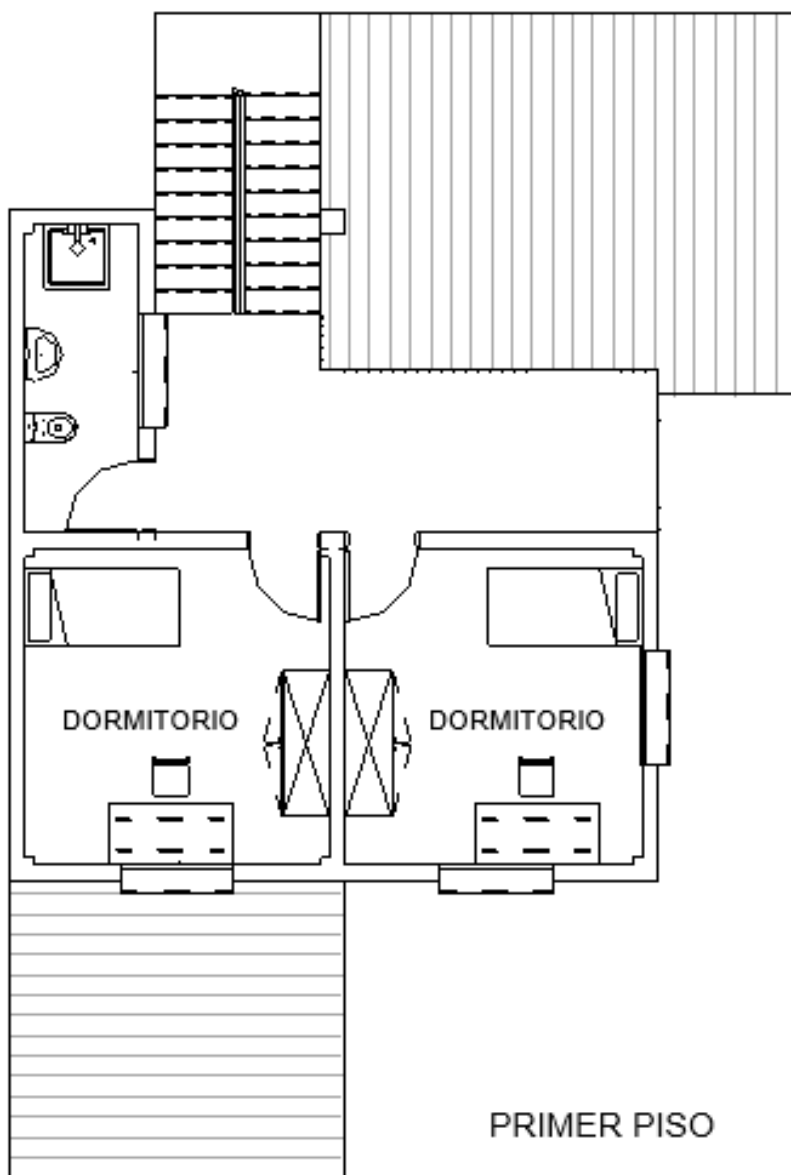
Planta Primer Piso de la vivienda unifamiliar
